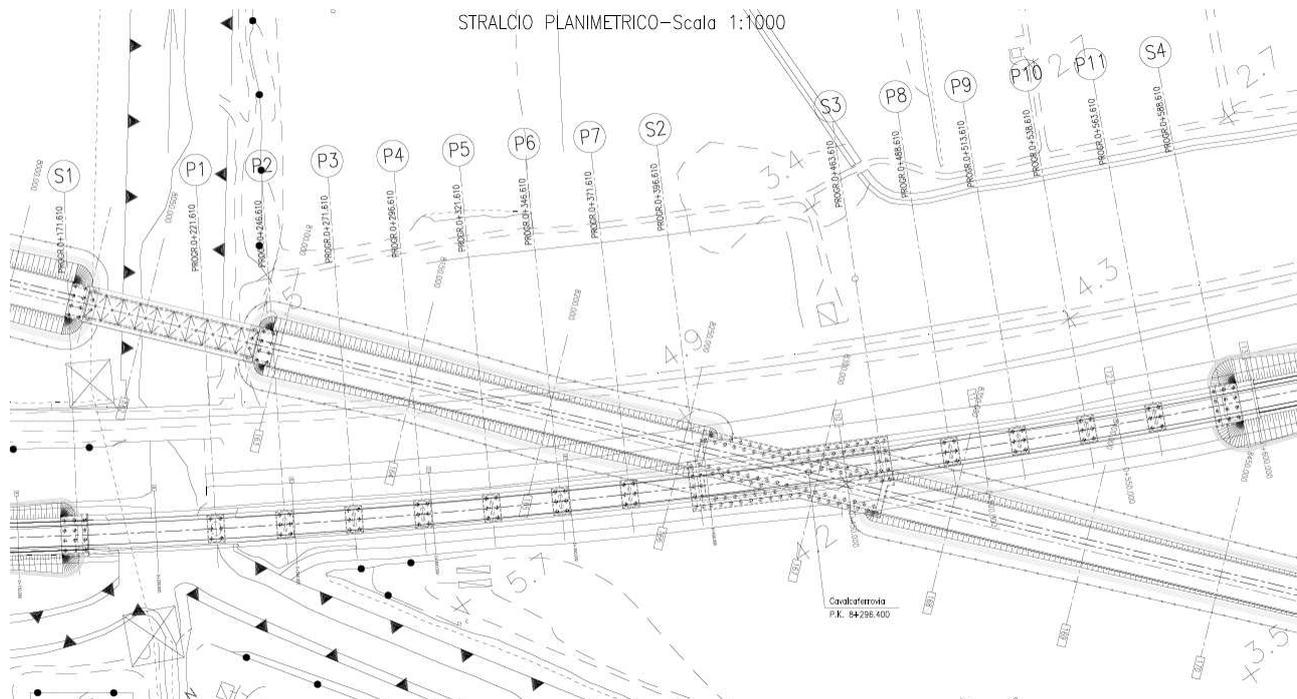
IV01 – GA02: stralcio planimetrico
